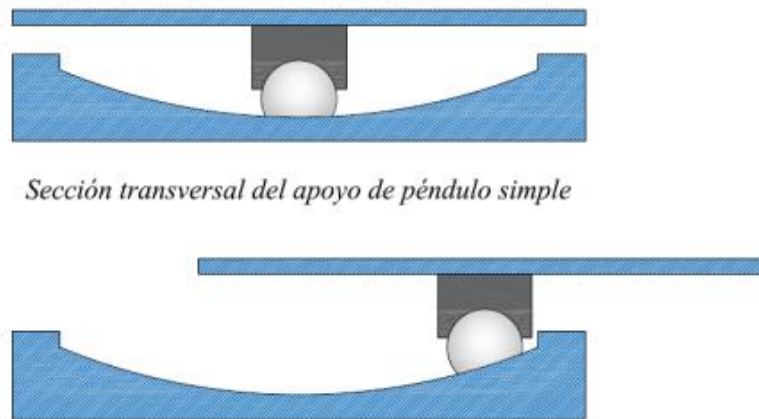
Aislador de base tipo péndulo de fricción simple. Nota. Corte transversal de un sistema de péndulo de fricción y su deslizamiento durante un evento sísmico. Fuente: Ramírez Tapia (2021).
